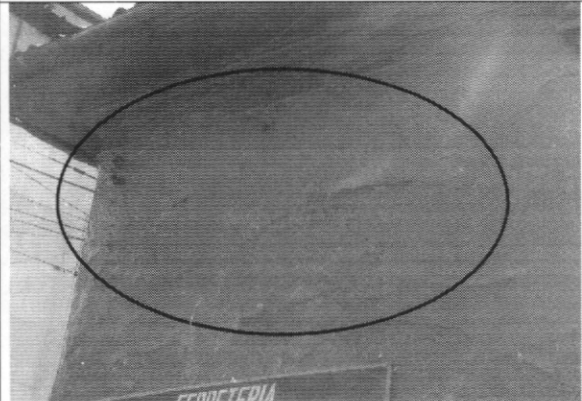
Fisuras y daño en acabados, costado norte
